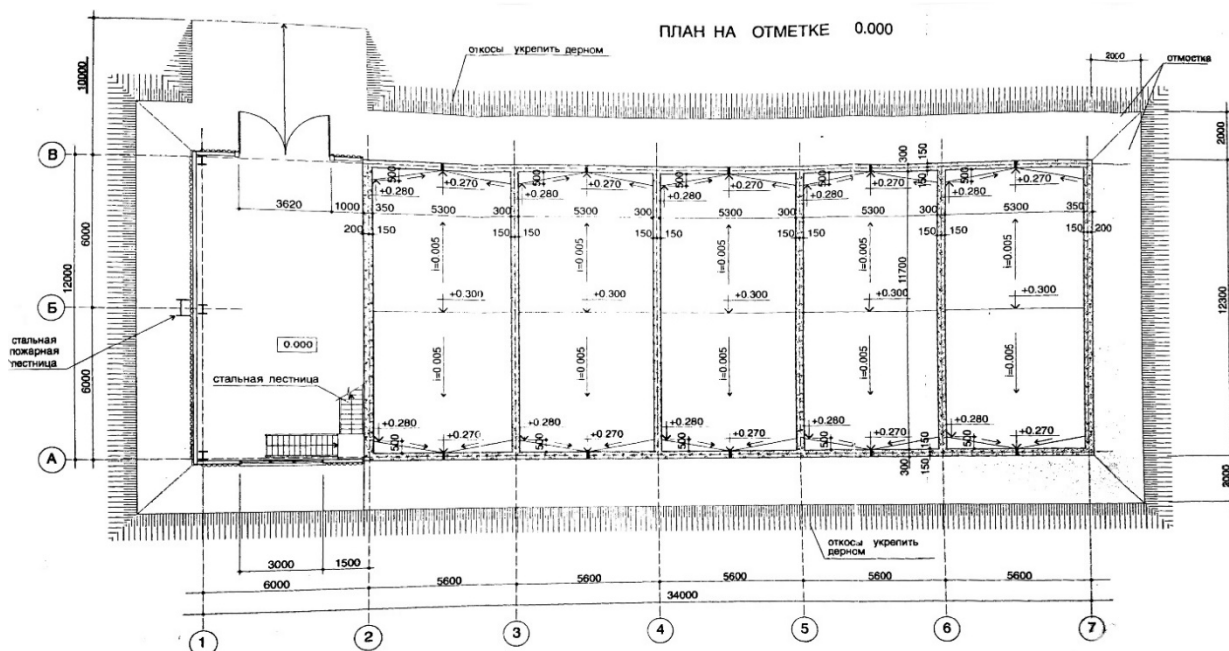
Схематичный план ХТРО ПЗ
